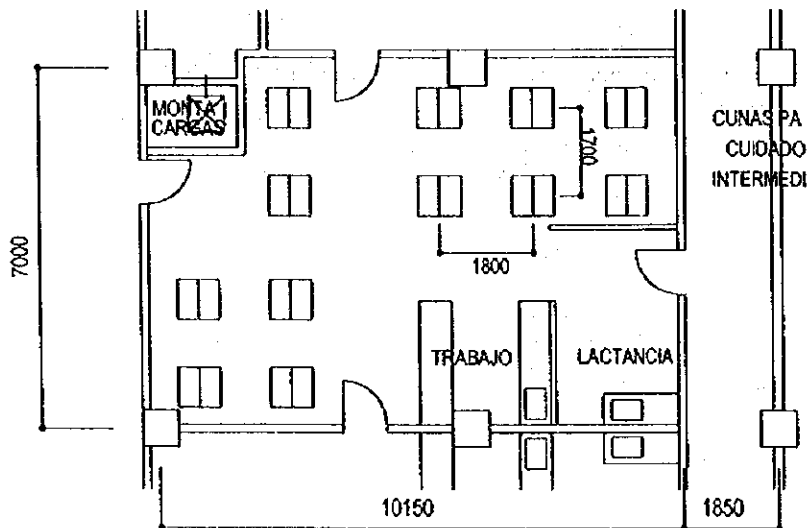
Plano de planta de distribución de las cunas en el Cuidado Intermedio
